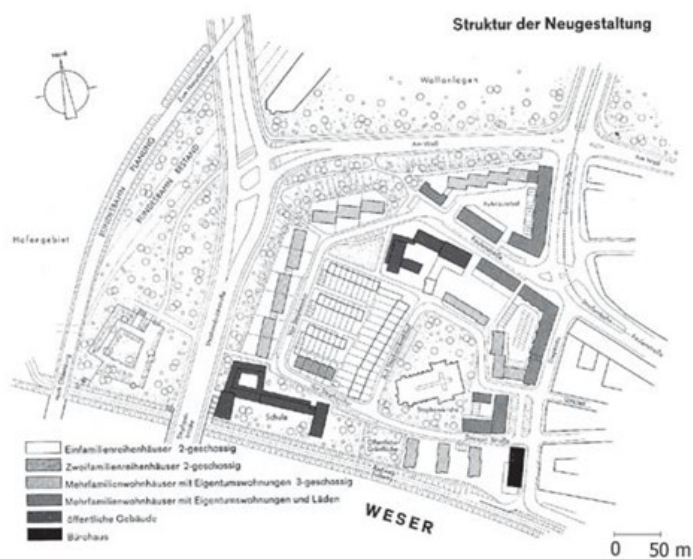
Lageplan Stefaniviertel (Haslob & a., 1988)
